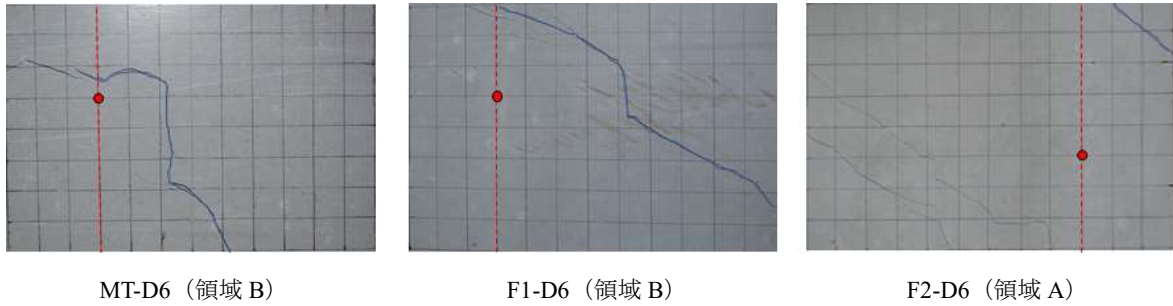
肋筋降伏時におけるひび割れ状況 (D6 シリーズ)
